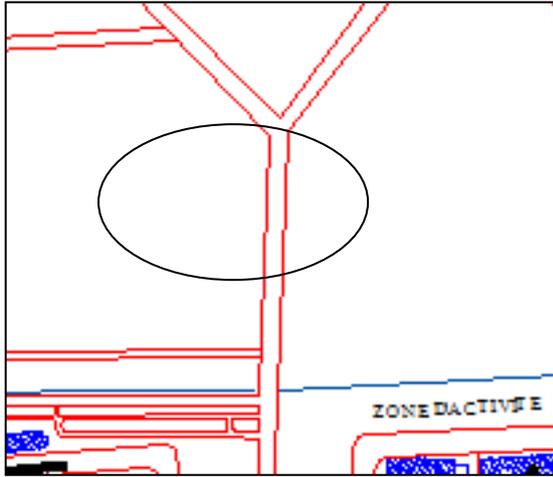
Vue en plan de l'assiette avant l'intervention
